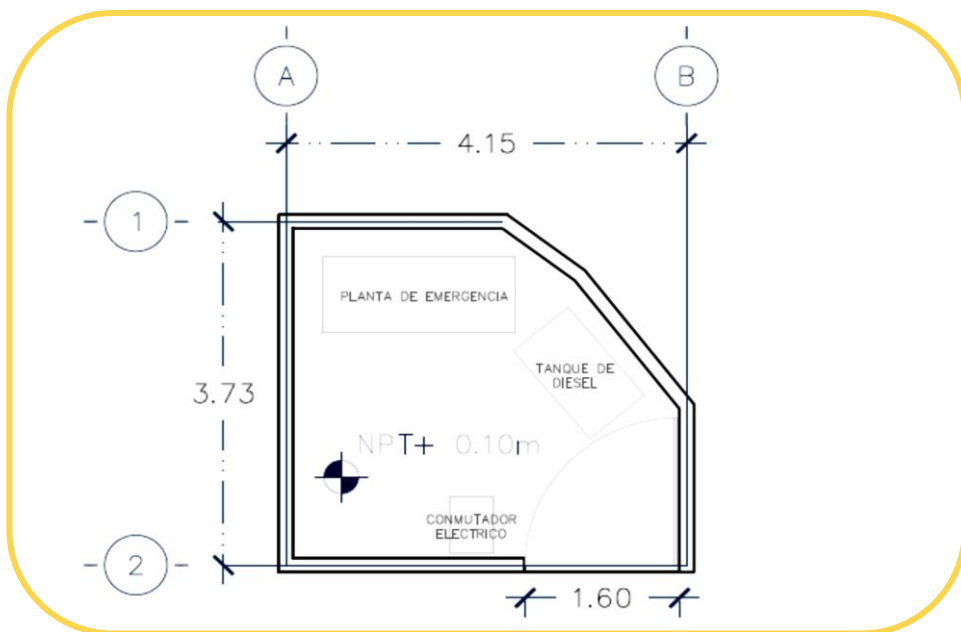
Planta Arquitectónica de la Planta de Emergencia.
